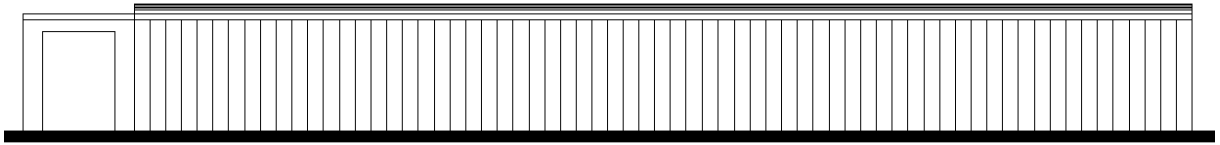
Façade Ouest (place de la cité les Bananiers) dessinée sur Autodesk-Autocad.
